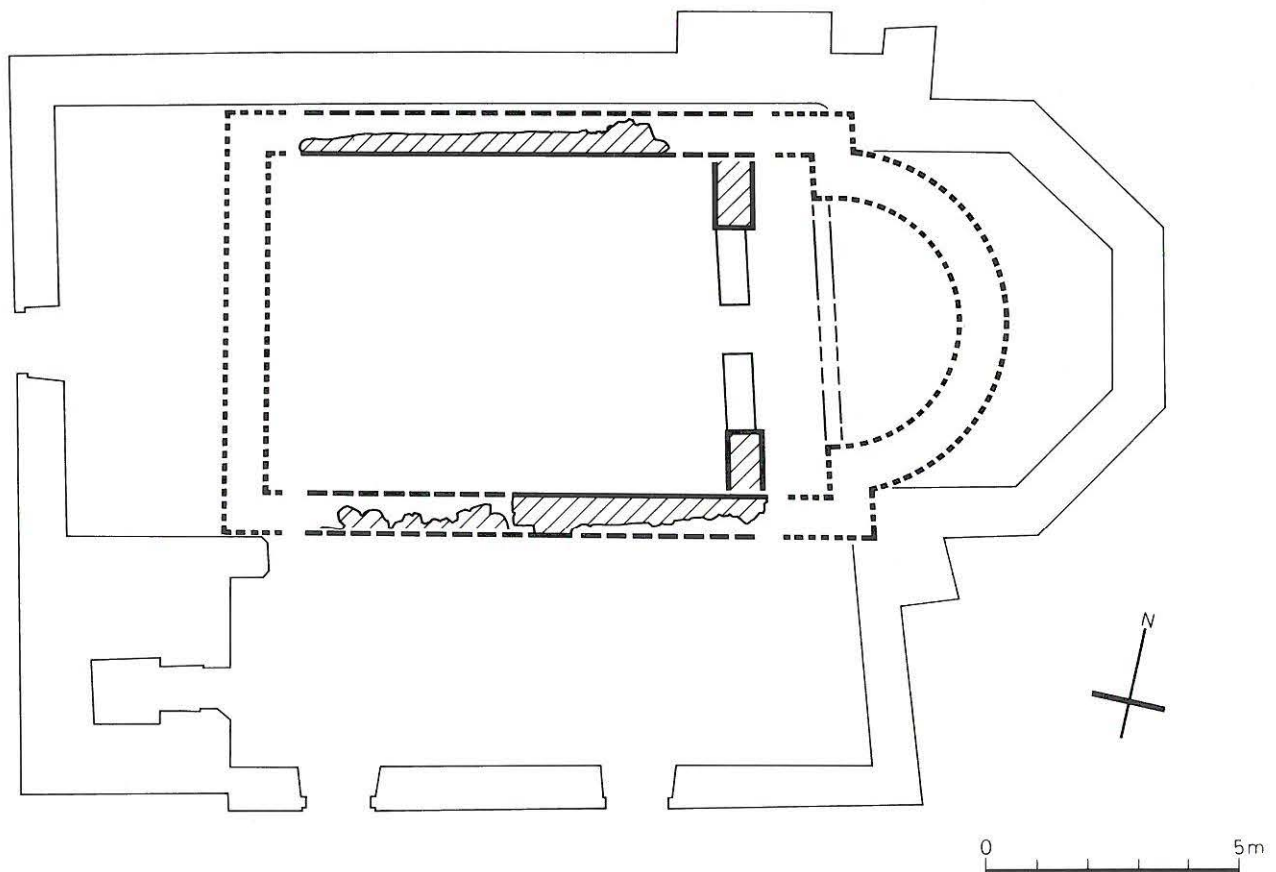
Rekonstruktion des Grundrisses der Kirche III (Fundament). M. 1:150.
